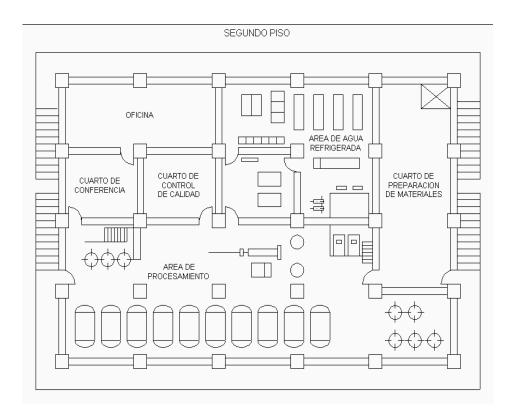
LAY OUT PLANTA DE BEBIDAS ÁREA DE PREPARACIÓN
